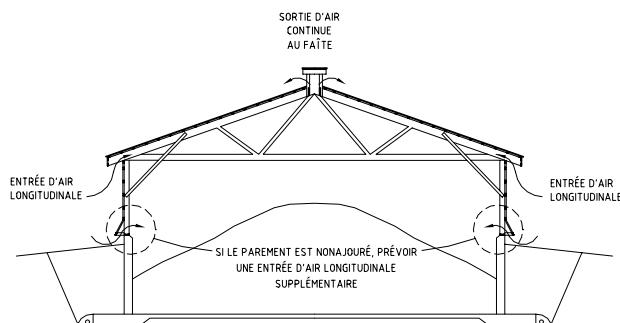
Coupe transversale d'un abri à fumier bien ventilé.
